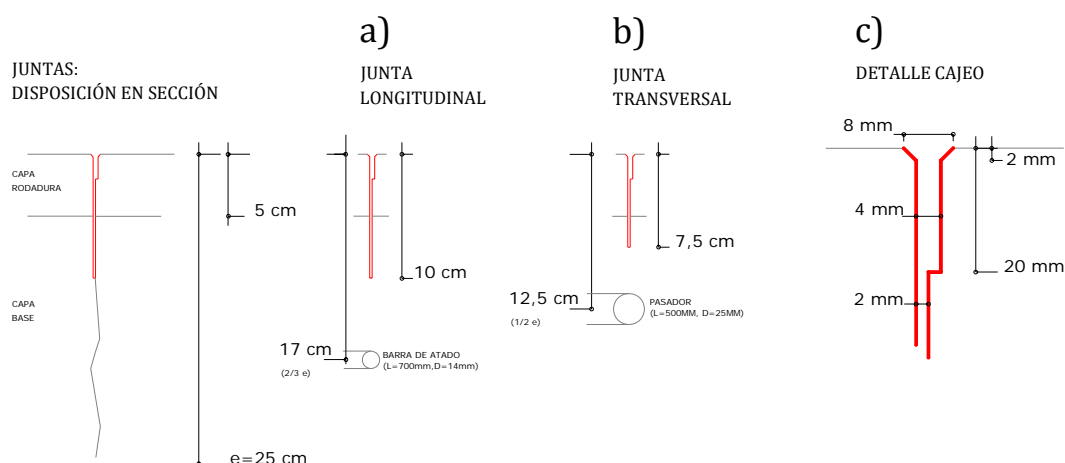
Sección transversal juntas longitudinales(a), transversales (b), detalle de cajeo y biselado(c)
